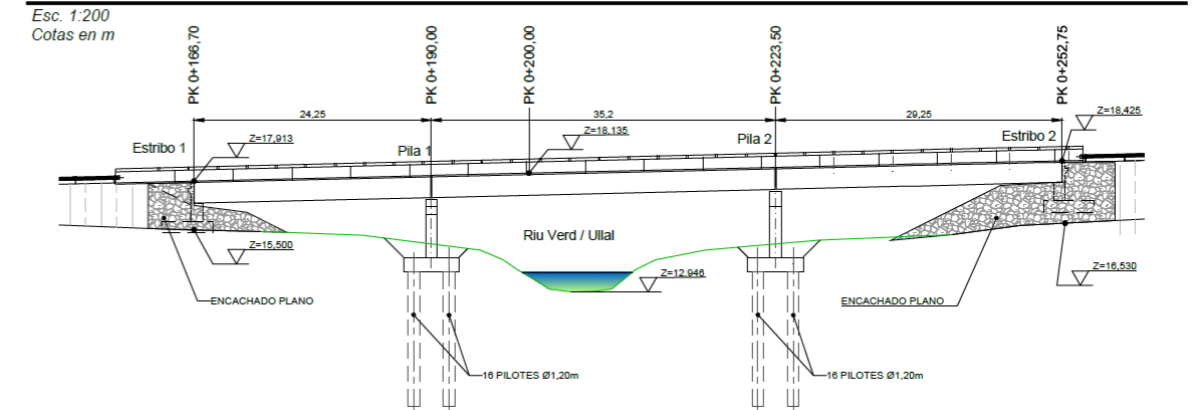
Alzado de la Estructura 1 sobre el Riu Verd.
